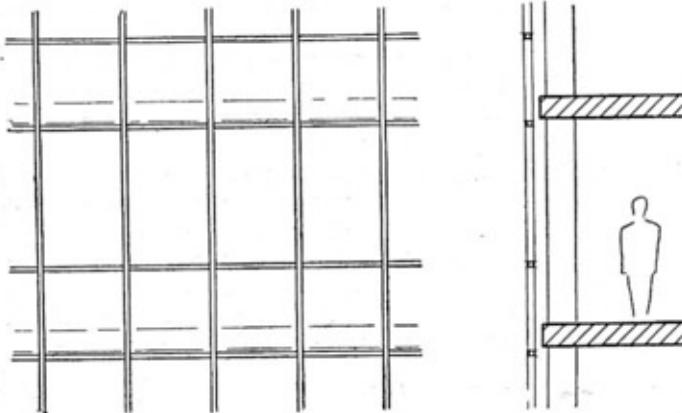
Горизонтальное членение фасада из навесных панелей увязано с высотой этажей
